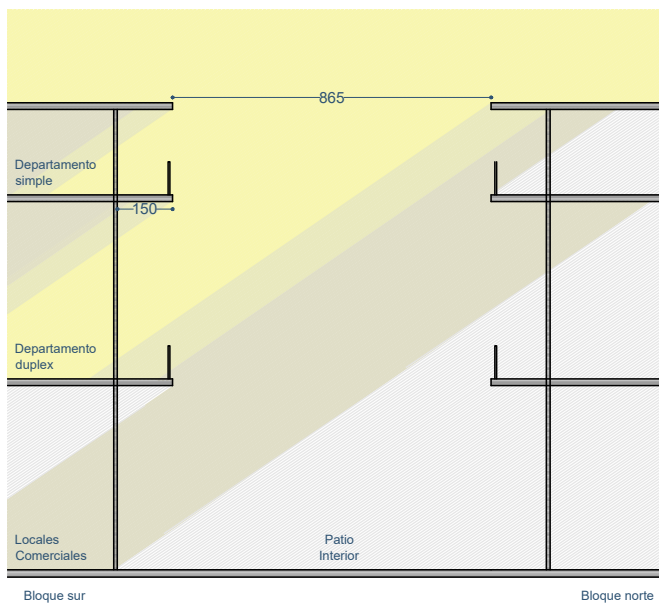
(Arriba) Recintos de fachada sur con doble orientación
